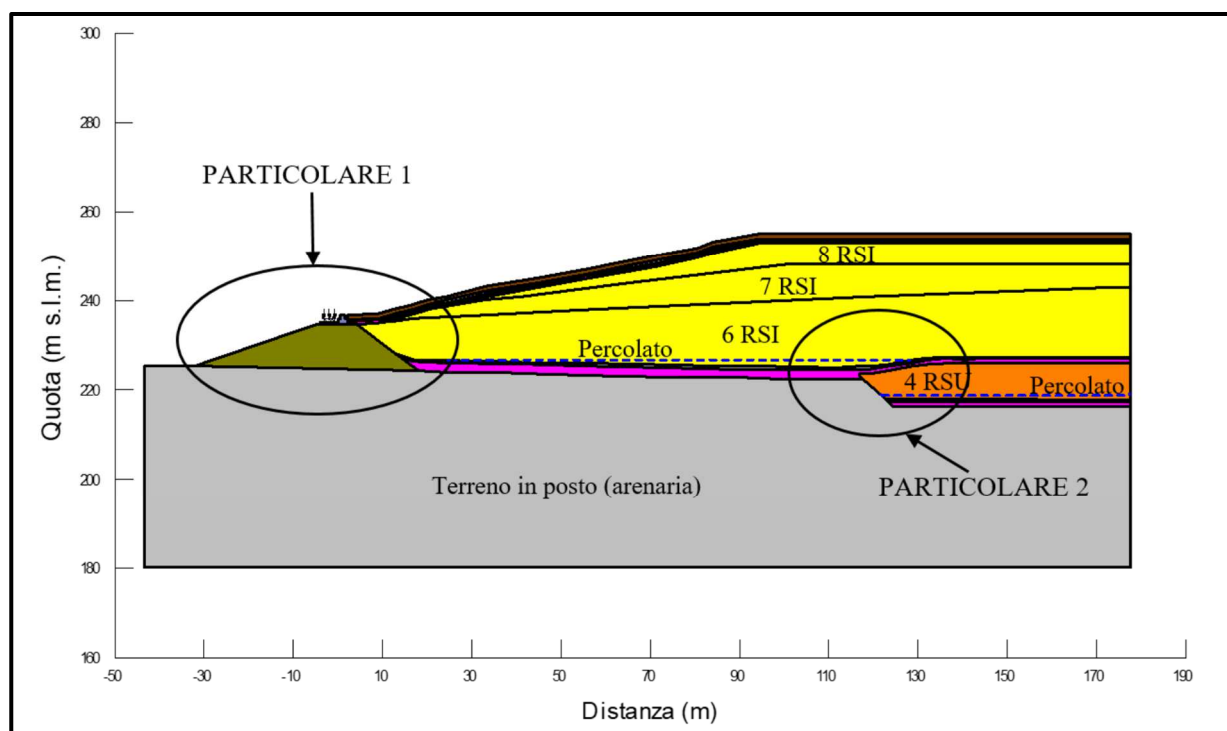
/I – Sezione A-A' – Sponda nord-est
